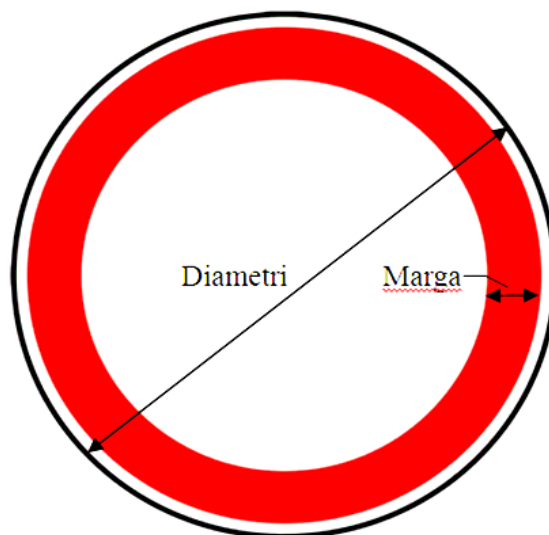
Dimensionet e shenjave të urdhrave të prera.
